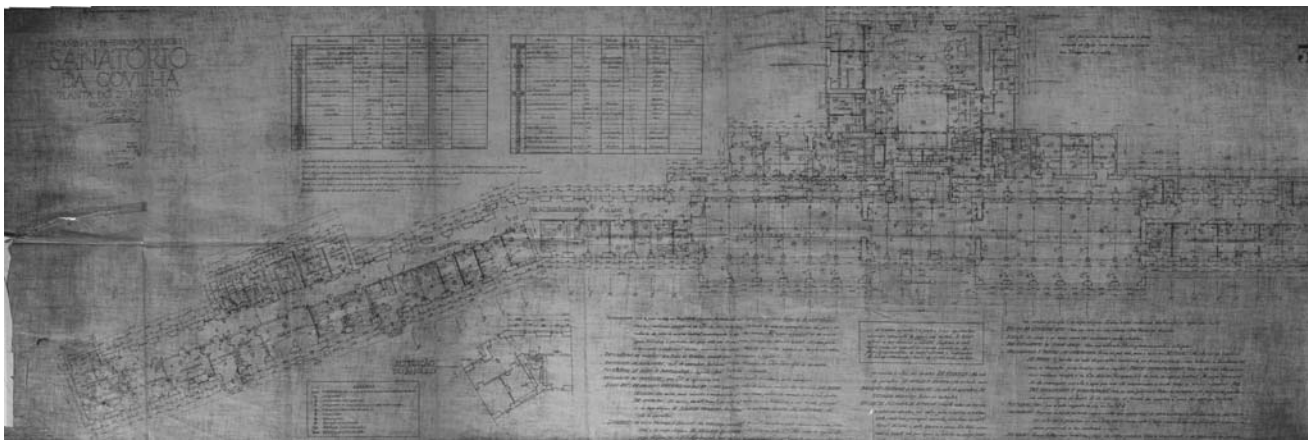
Planta do 2º. Pavimento. Cottinelli Telmo. SIPA [DREMC]: DES\_3(prov.).
